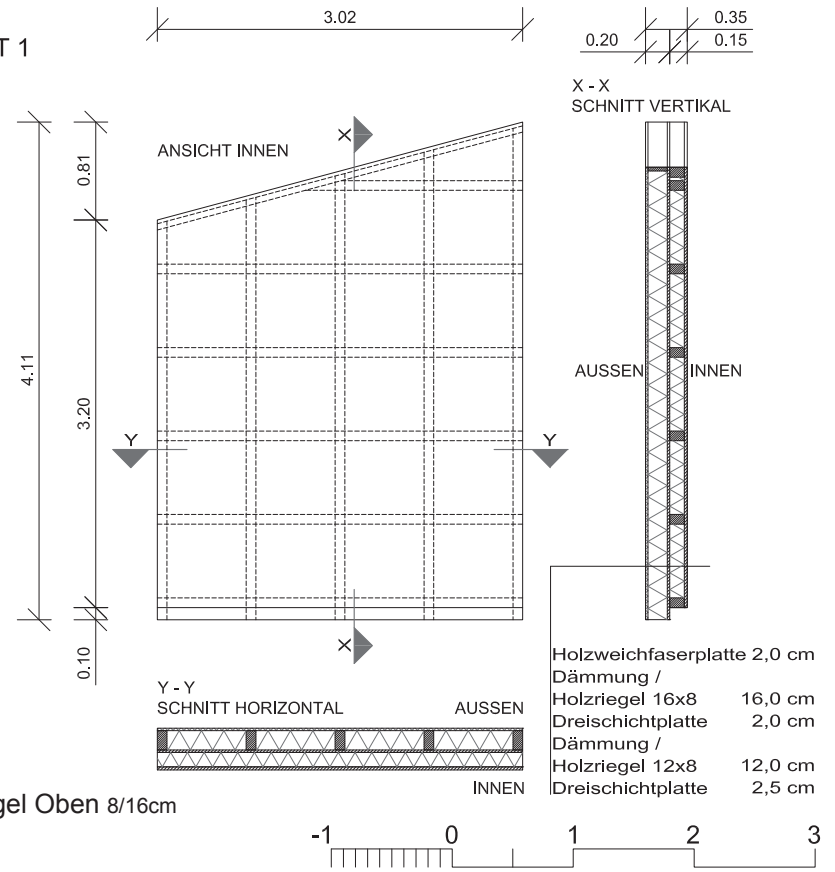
| Giebelelement 1 Ansicht und Schnitt
